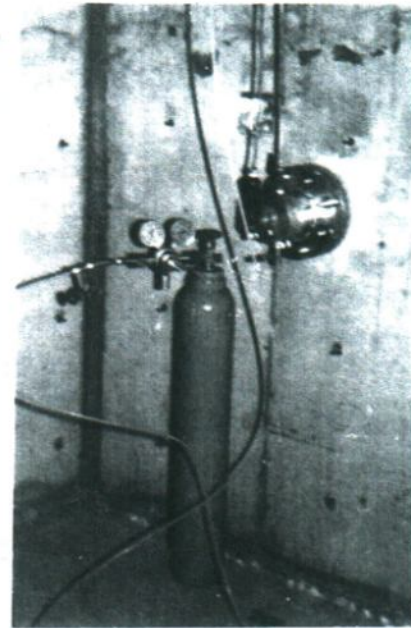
Montajul pentru determinarea permeabilității betonului în secțiunea elementului
